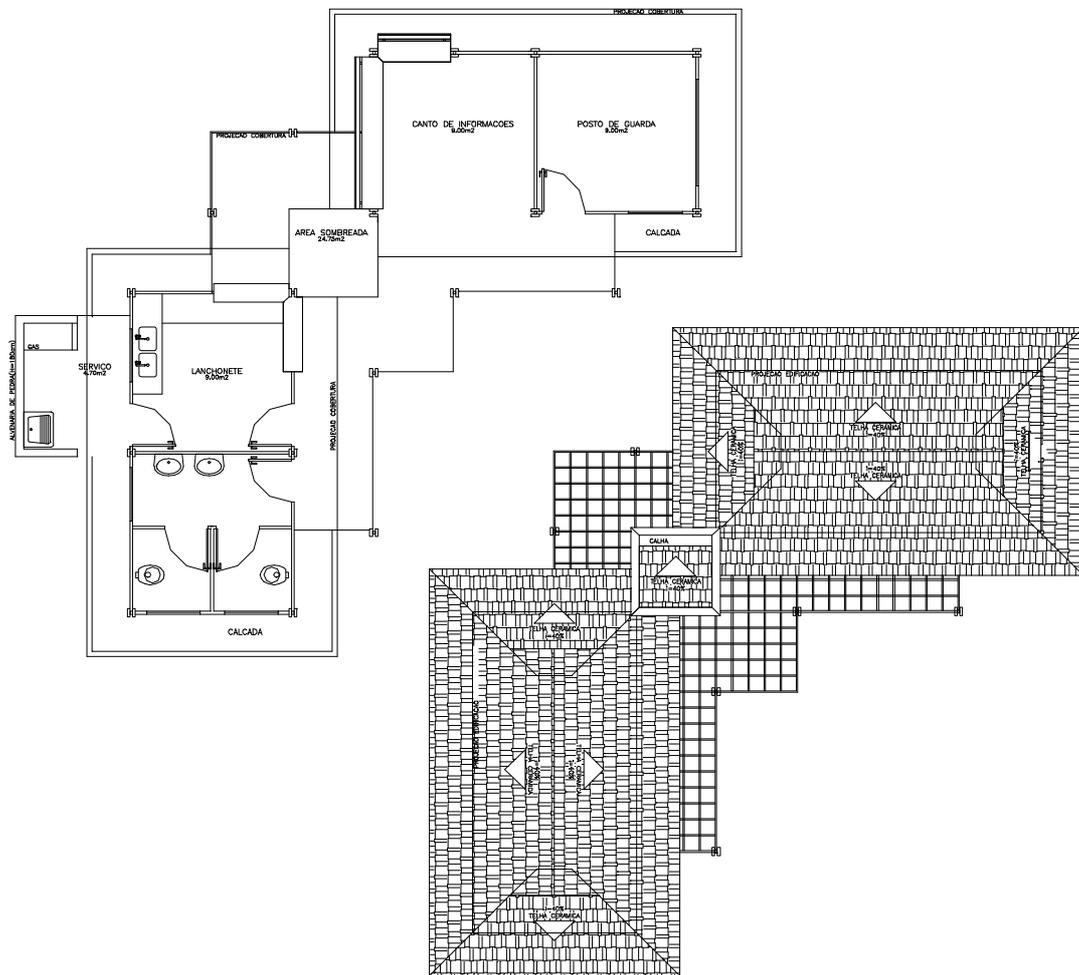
Plantas baixas de um “PIC”, observando-se o caráter modular do projeto
